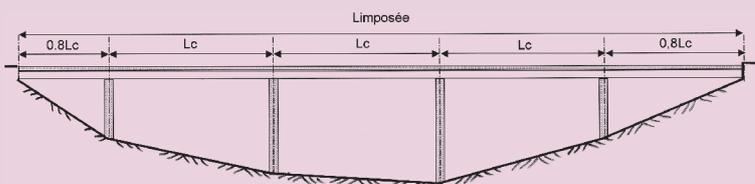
Ouvrage avec position des culées imposée et travées de rive « longues »
